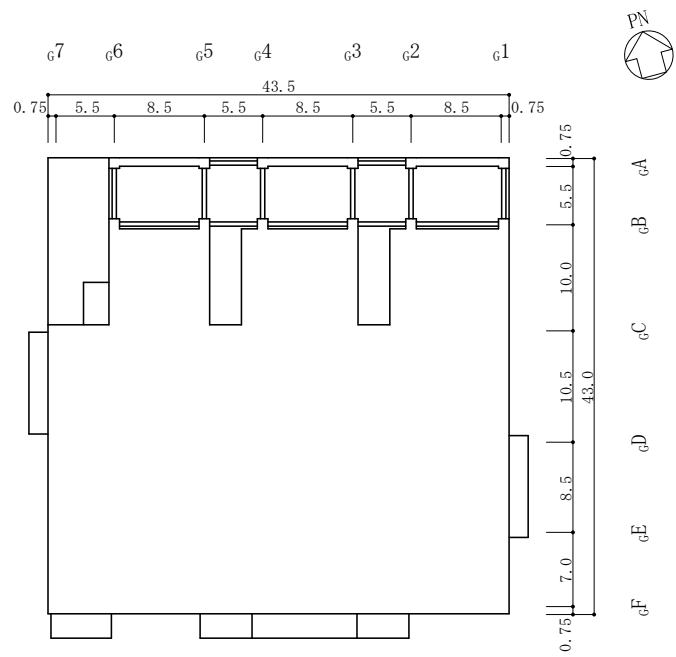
(1) ガスタービン発電機建物の概略平面図 (EL 47.5m*)
